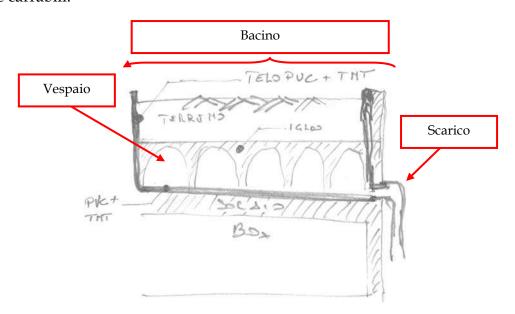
Schema del sistema di impermeabilizzazione e convogliamento acque
